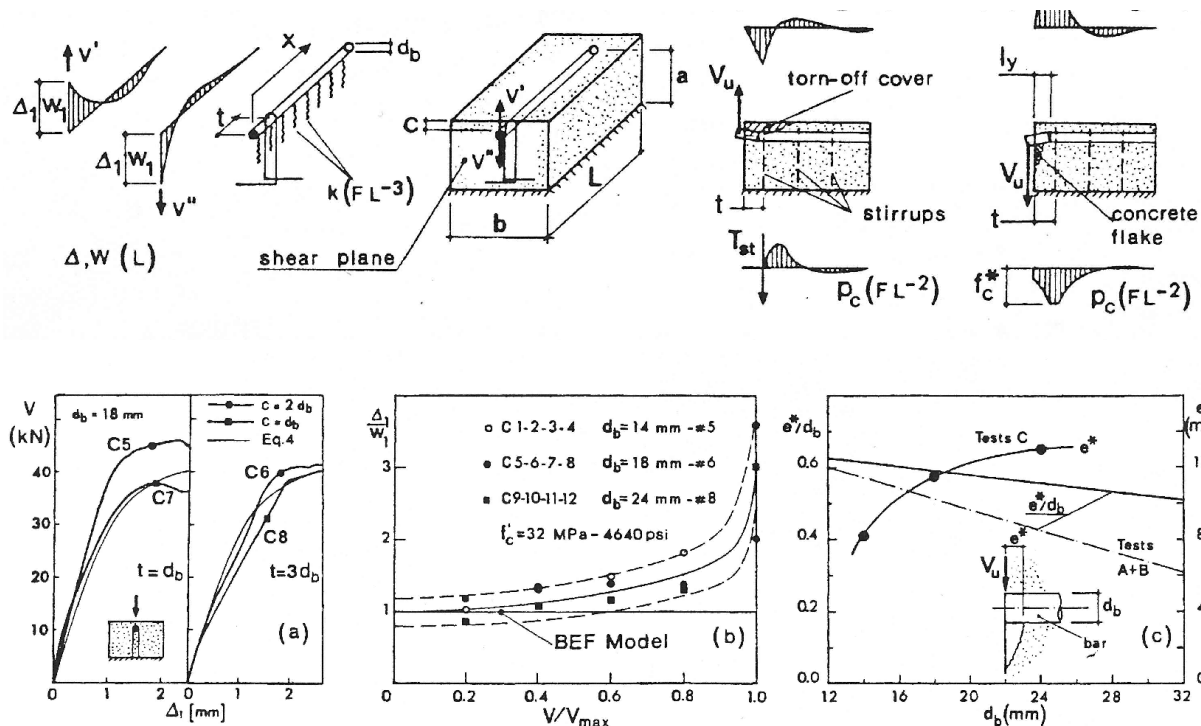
a) Schematische Darstellung des angenommenen Tragmodells von querbelasteten Bewehrungsstäben am Bauteilrand und b) Ergebnisse der Untersuchungen aus Jayas und Hosain (1987) für Bewehrungsstäbe am Bauteilrand mit und ohne Rückhängebewehrung.
